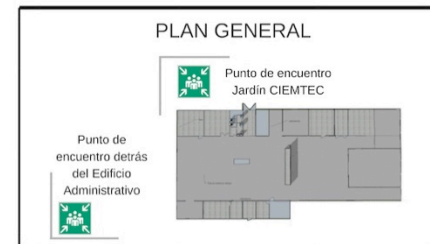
Croquis de evacuación Planta Baja CIEMTEC I1
